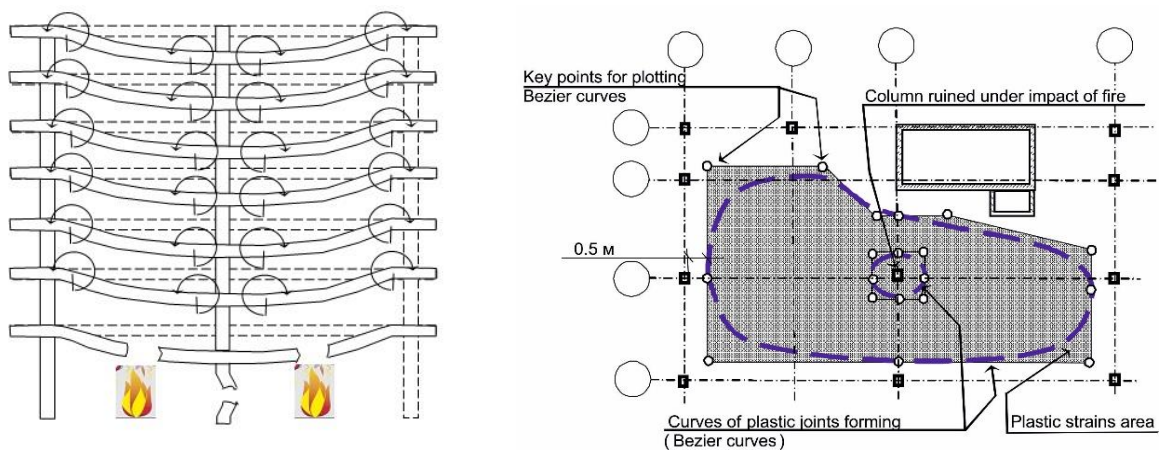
Розрахункова схема для розрахунку прогресуючого руйнування будівлі із залізобетонними конструкціями. Відтворення ліній утворення пластичних шарнірів за допомогою кривих Без'є
